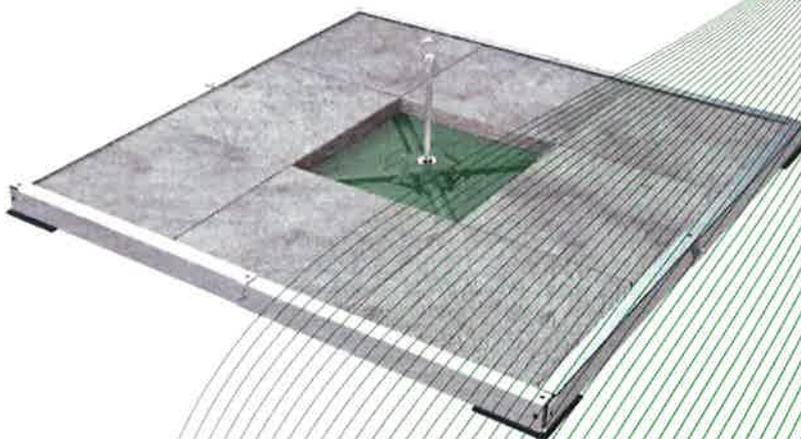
Dispositif d'ancrage, type : Weight onTop, avec dalles de béton
